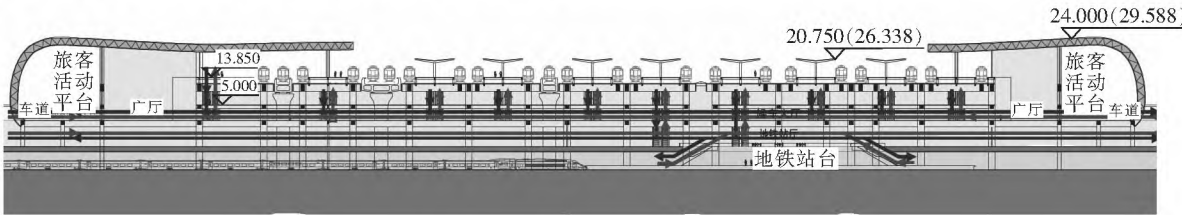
方案Ⅱ柱网布置剖面图(单位:m)
